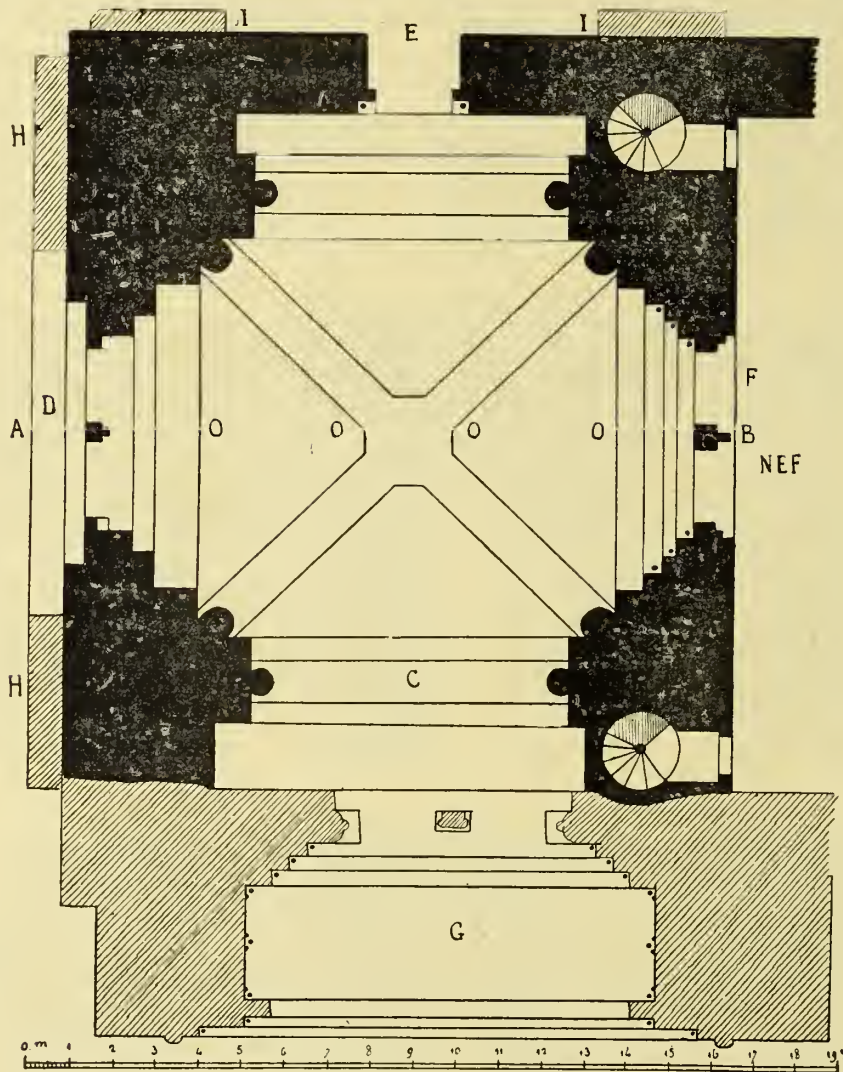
PLAN A REZ-DE-CHAUSSÉE DU PORCHE DE L'ÉGLISE DE MOISSAC
